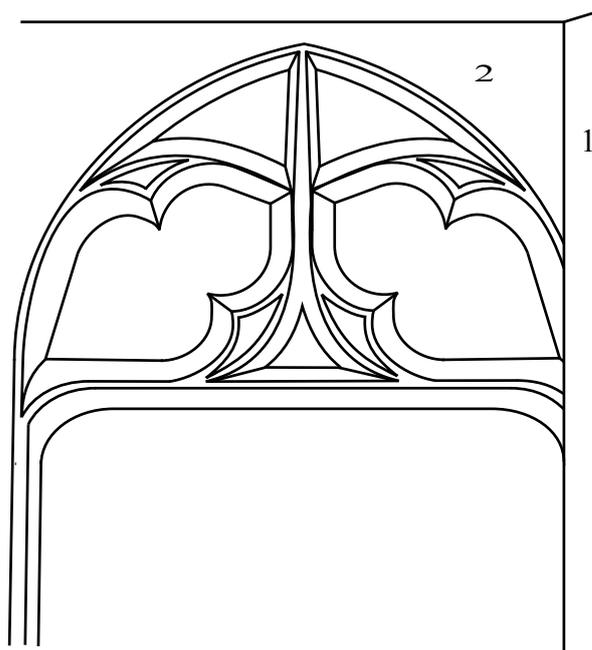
Schéma du remplage de la porte gothique, aujourd'hui murée, de la salle A :
